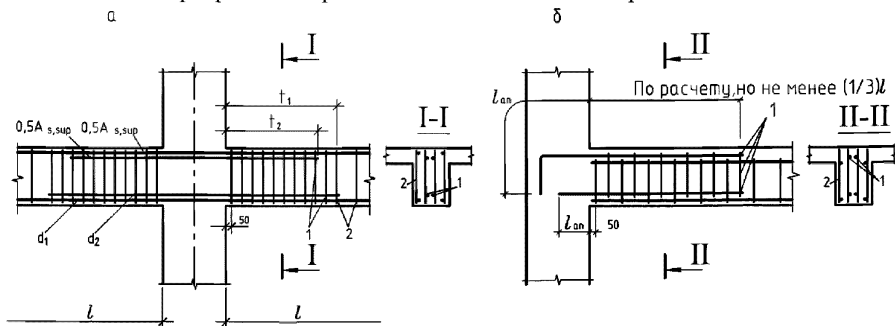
Армирование опор монолитных главных балок сварными сетками: *а* – средних; *б* – крайних; 1, 2 – сетки соответственно опорная и пролетная; l_1 – по расчету, но не менее $(1/3)l$, l_2 – по расчету, но не менее $(1/4)l$
